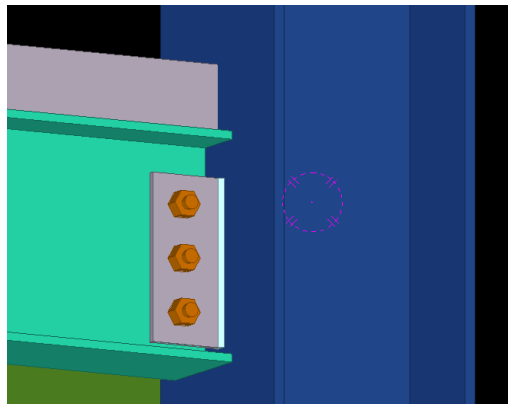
Conexión a cortante que une la viga con la columna. Fuente: PERALTA
